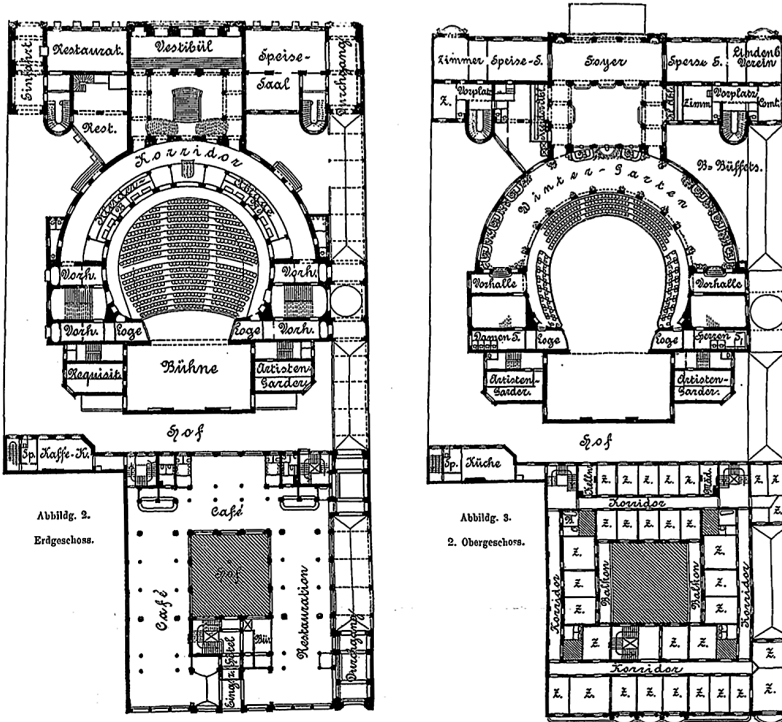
Grundriss des Metropol-Theaters mit dem angeschlossenen Hotel Lindenhof.
